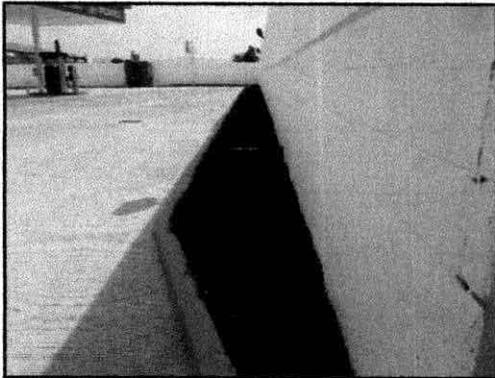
Bardas en las Colindancias sur y poniente
